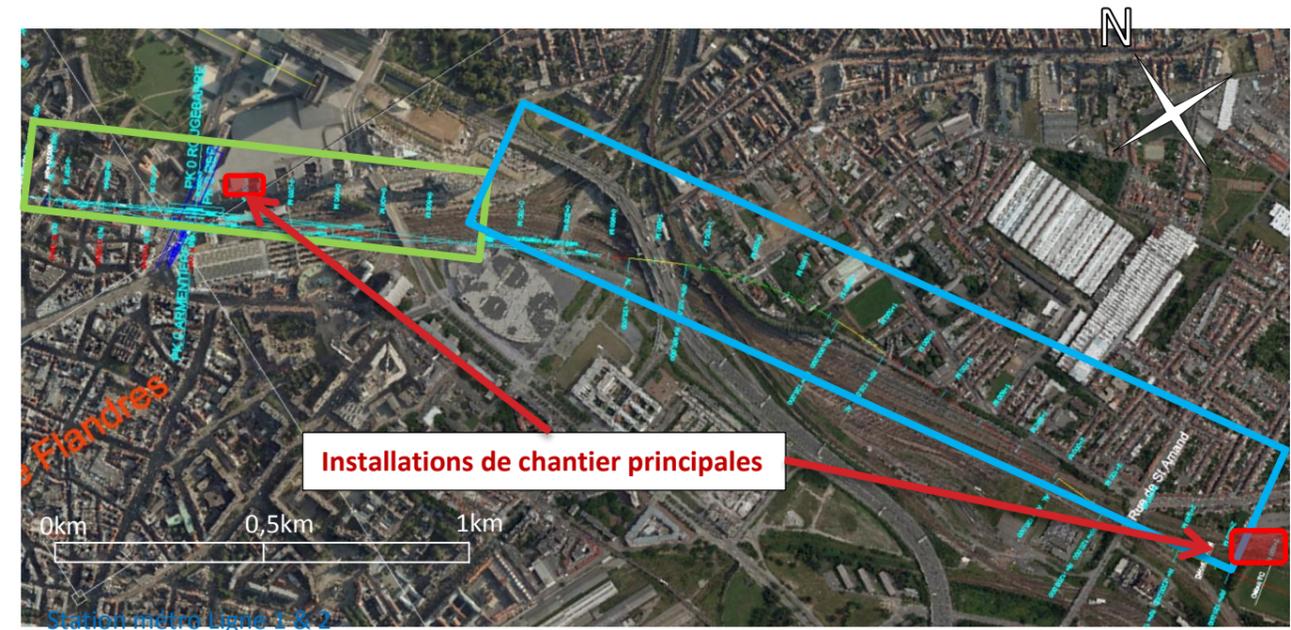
Traversée de Lille en souterrain : Secteurs d'étude
